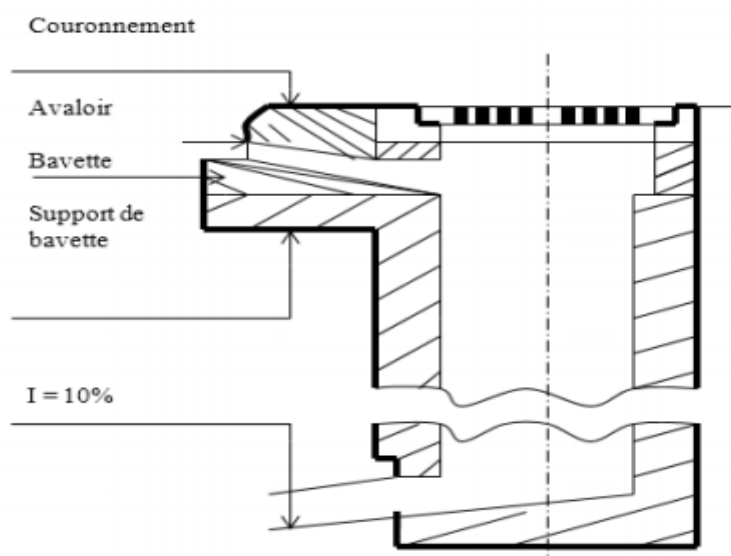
Exemple d'une bouche d'égout sans décantation.
